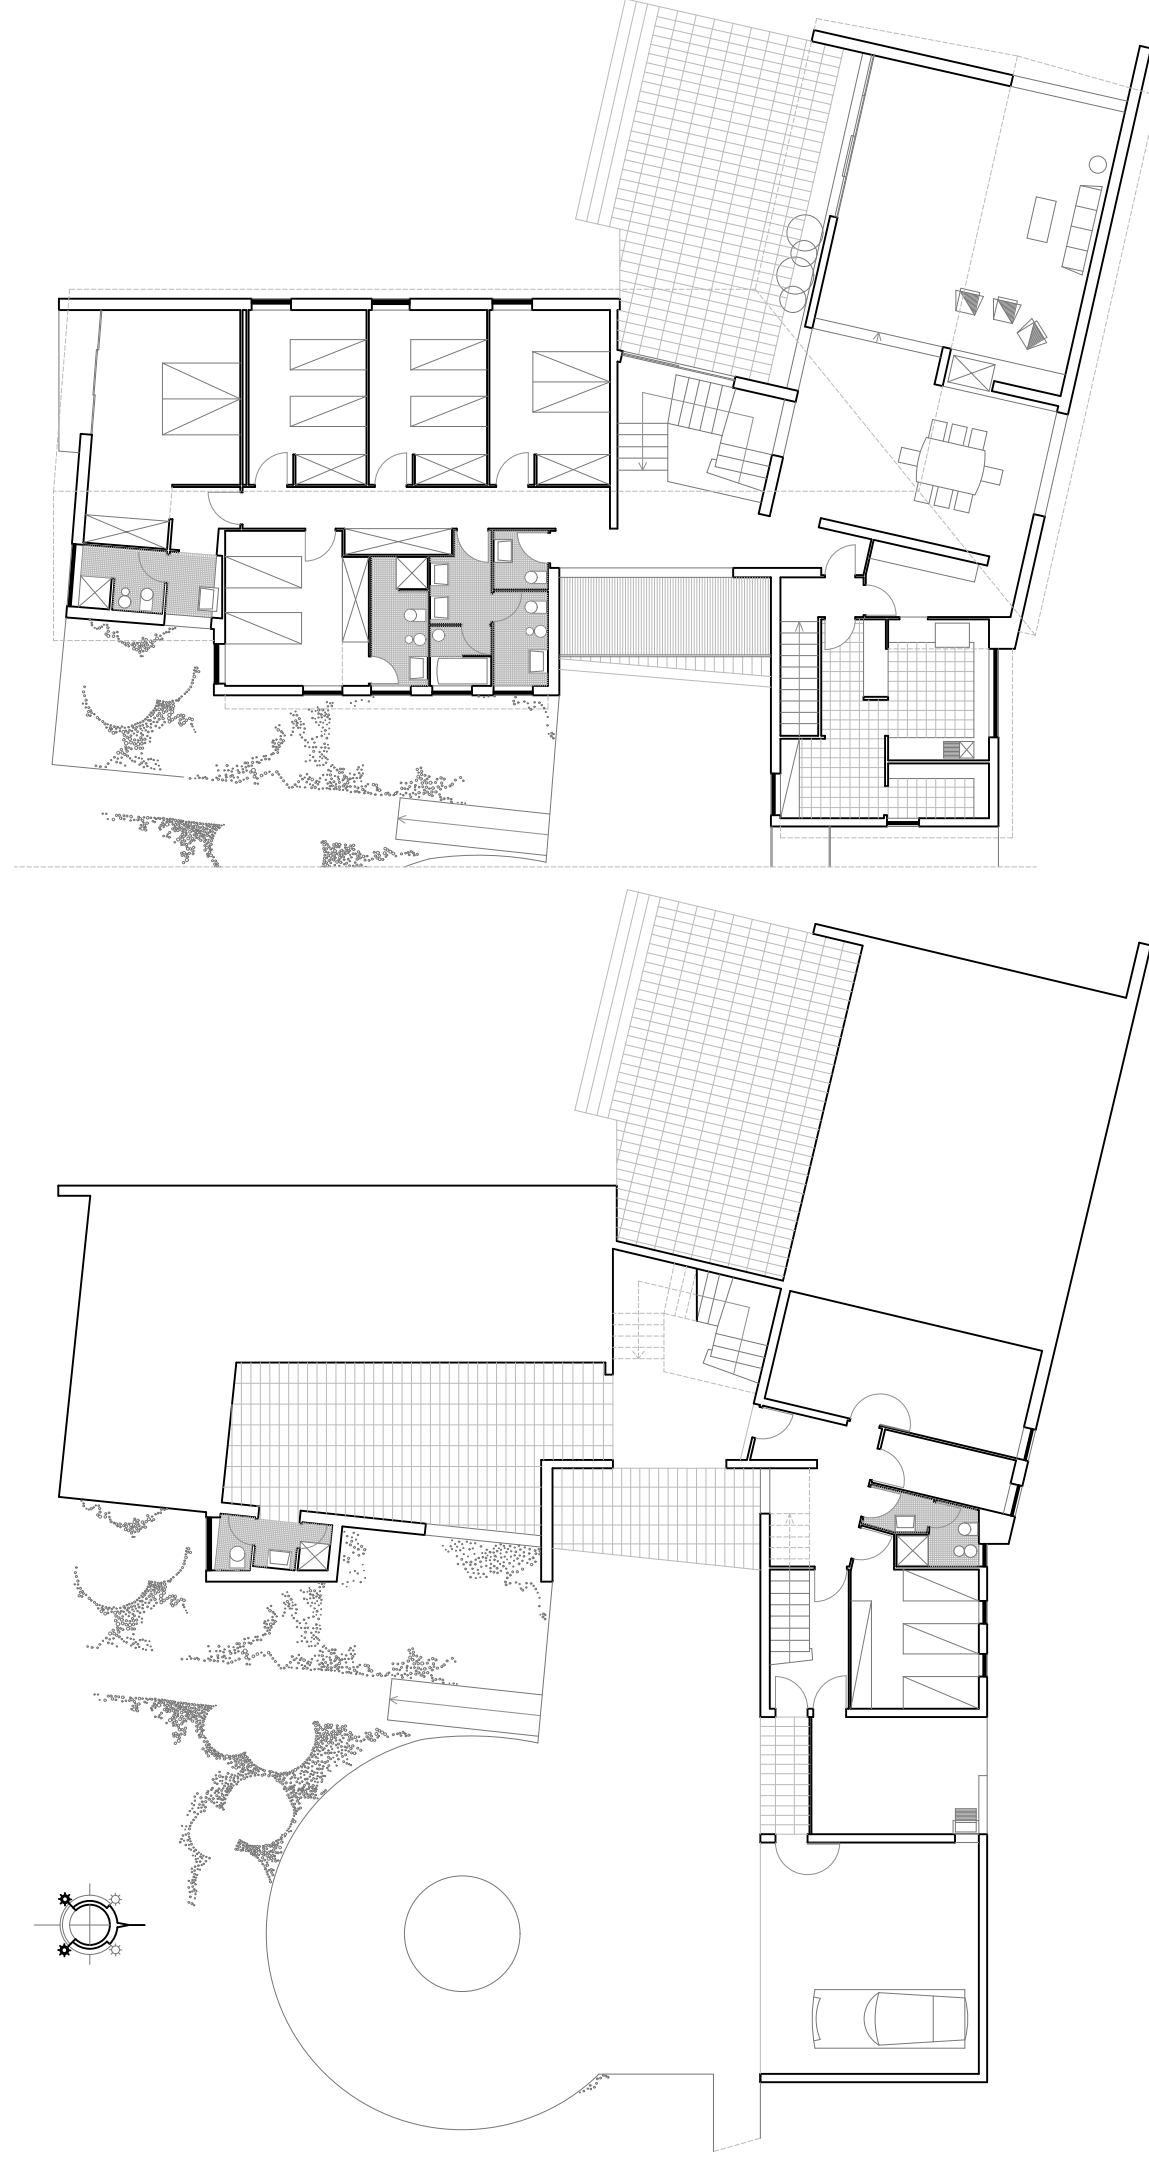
Planta de rés-do-chão e planta de cave da Casa Pimenta Machado - escala 1.200.
